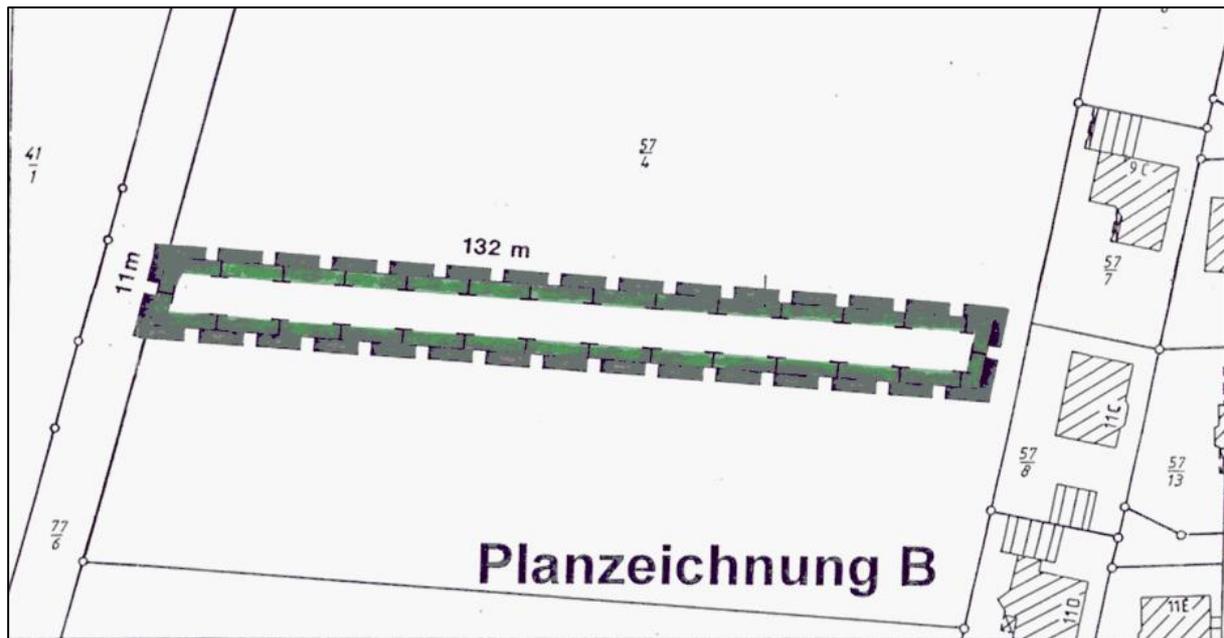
Auszug „Planzeichnung B“ Ursprungsbebauungsplan
